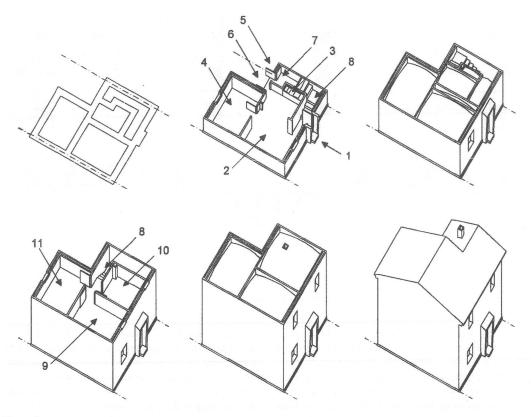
Proceso constructivo de las viviendas de dos plantas del barrio de Sant Cugat (dibujo de Ramón Ripoll)
